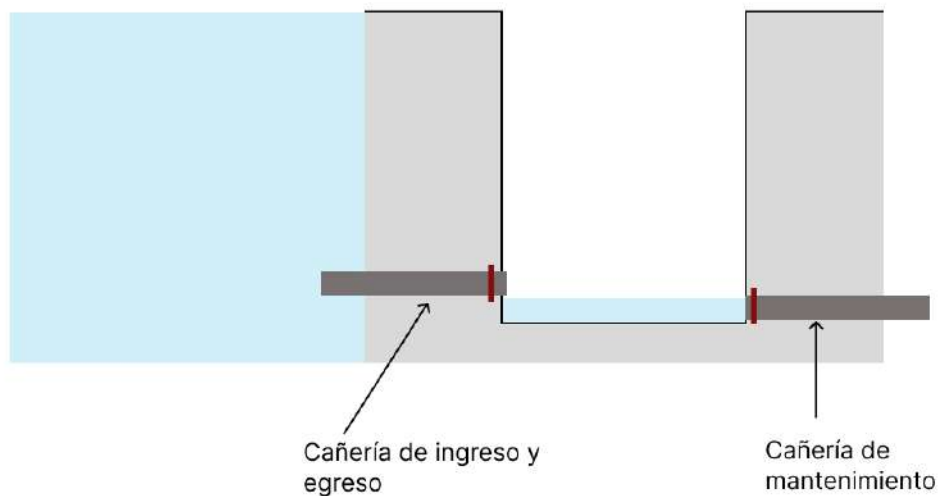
Vista frontal de piletones con cañerías Fuente: elaboración del autor
